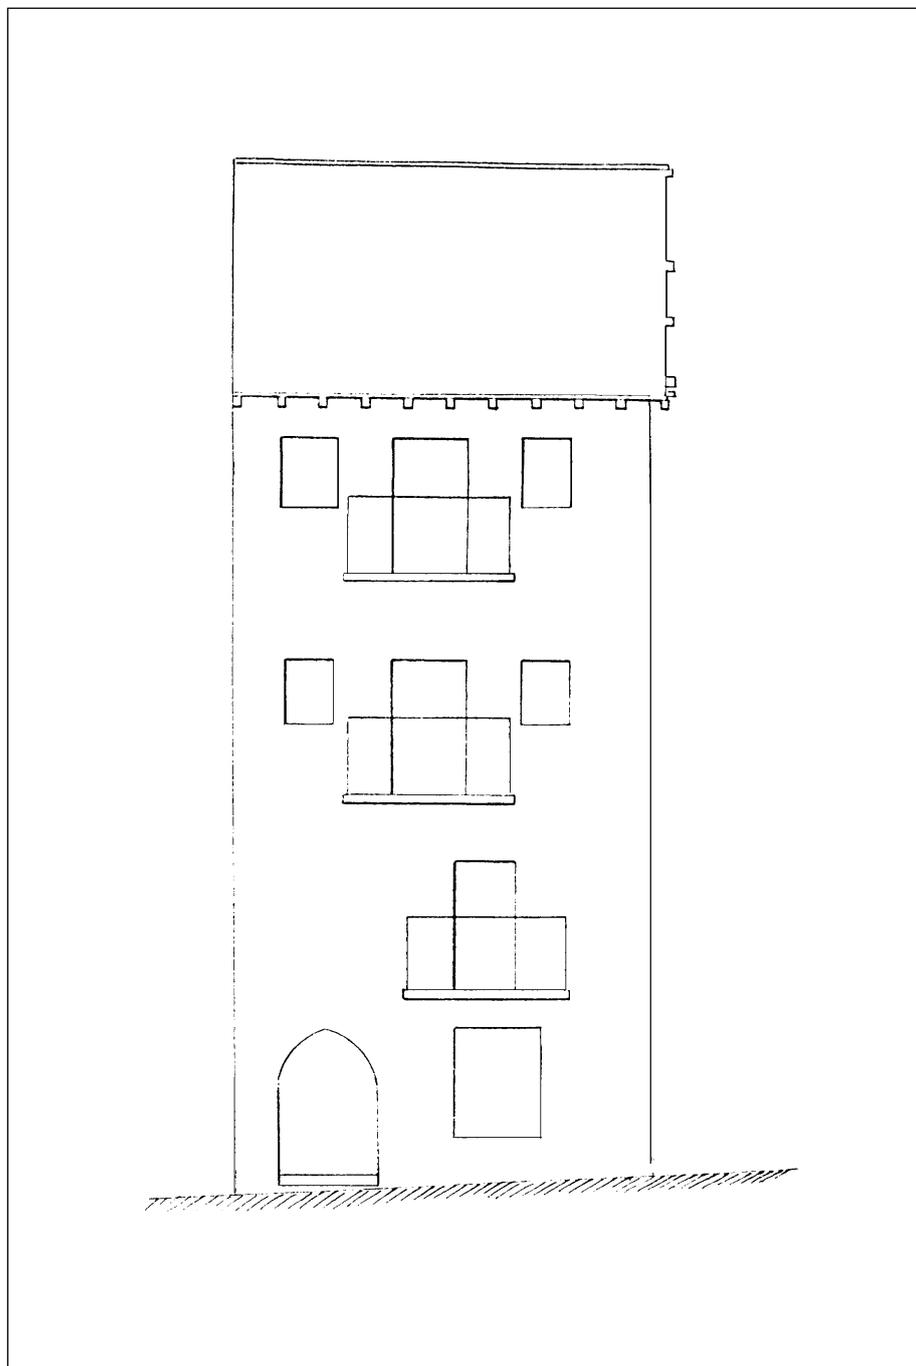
Alzado de la fachada principal de la casa nº 4 del cantón de Lope García de Salazar, en 1879.
